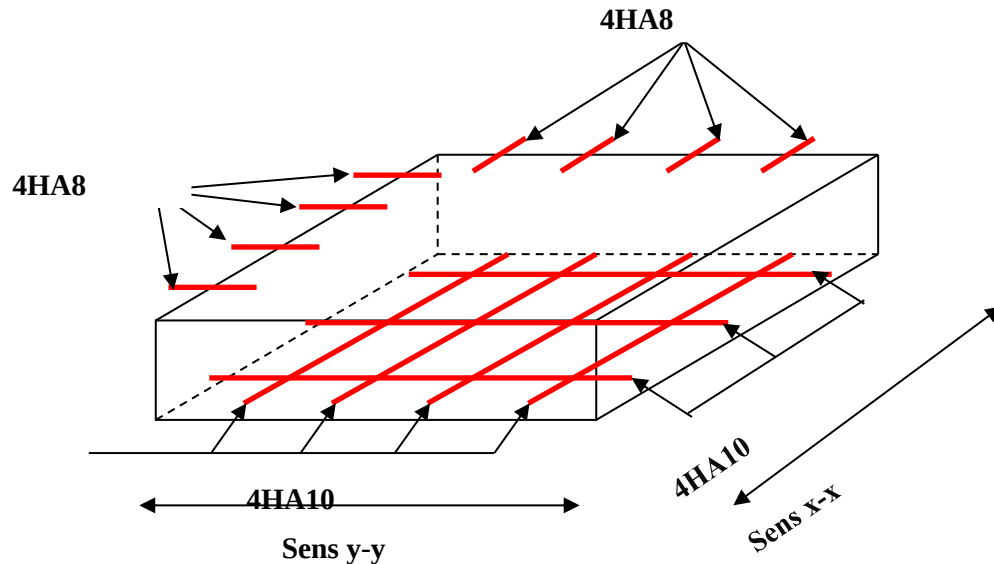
Schéma de ferrailage de la dalle de l'ascenseur.
